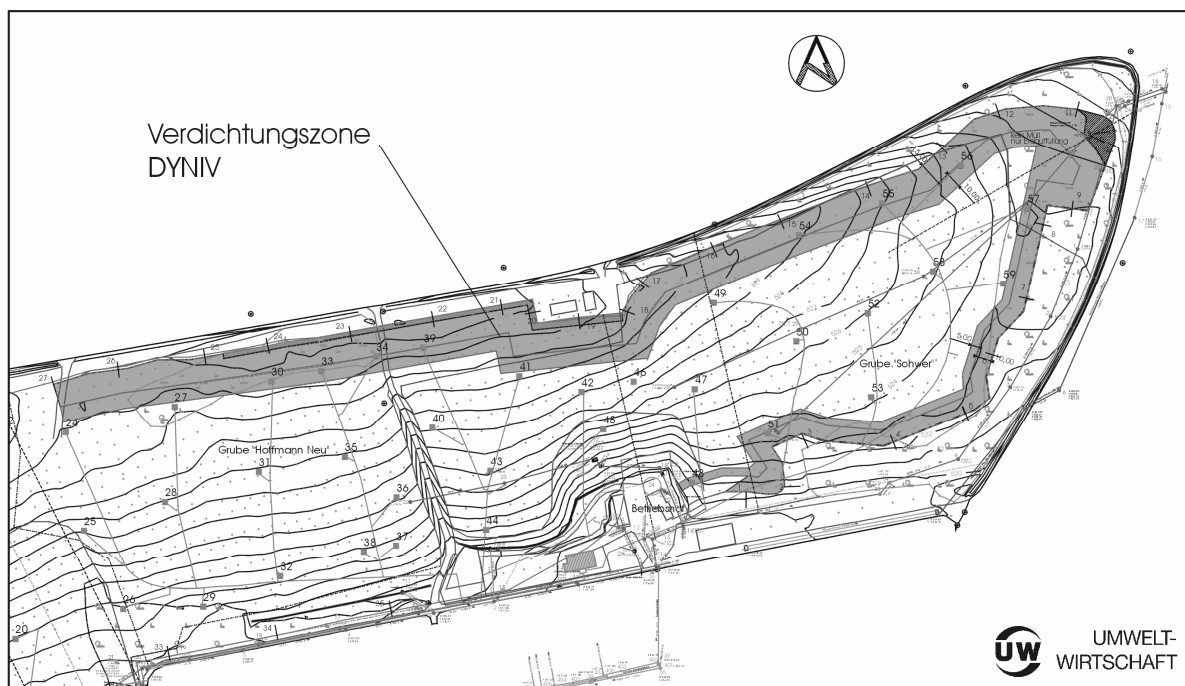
Lageplan mit Darstellung der Verdichtungszone
